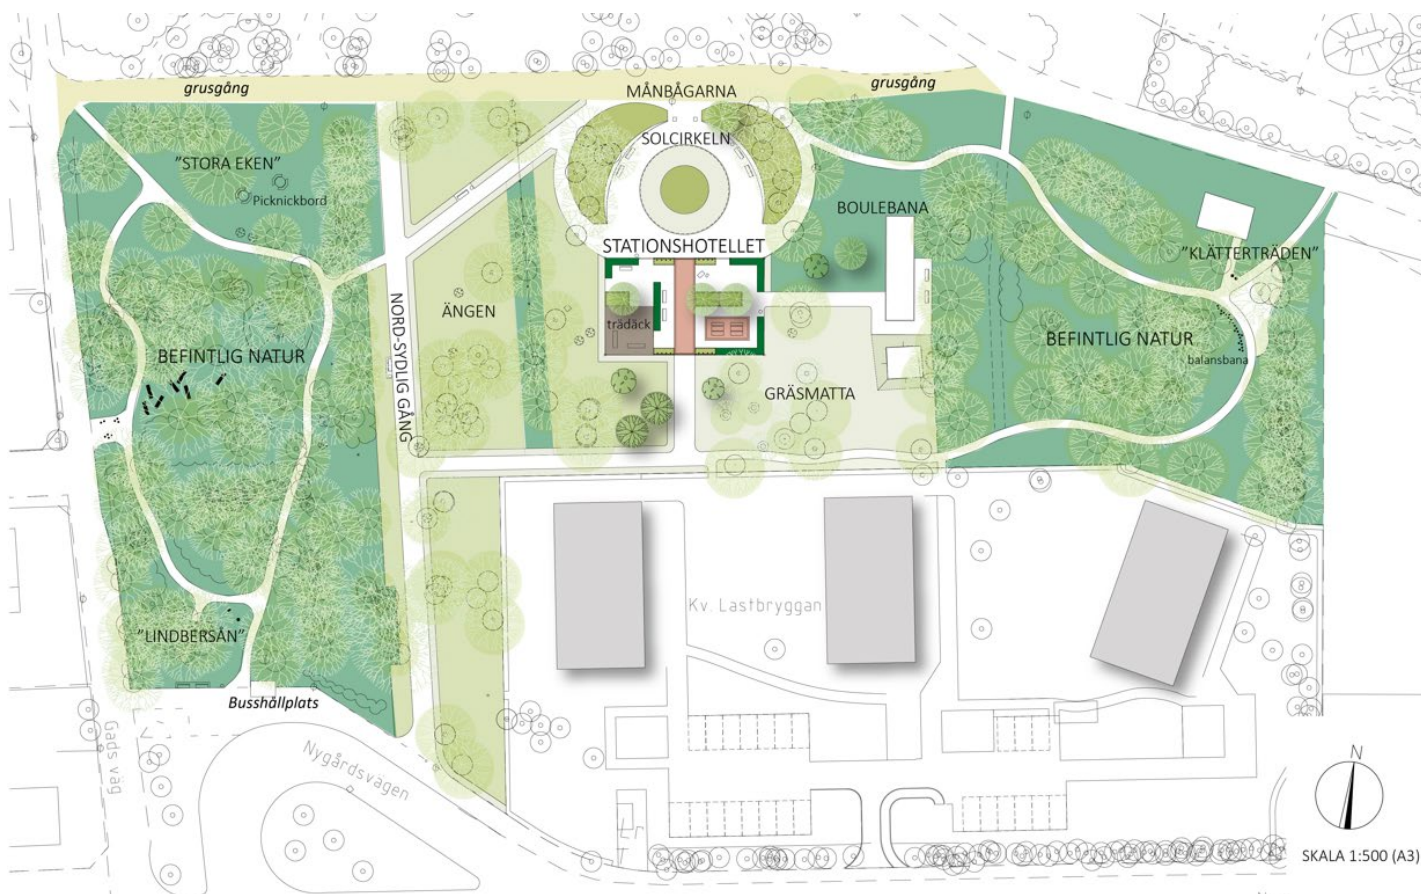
Illustrationsplan för södra delen av Stationsparken.
